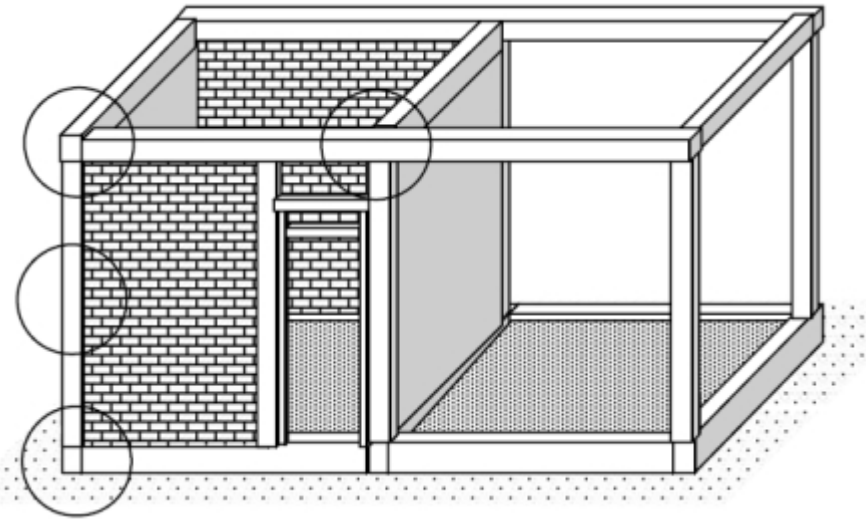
DETAIL HUB. KOLOM BETON TENGAH DENGAN RING BALOK
